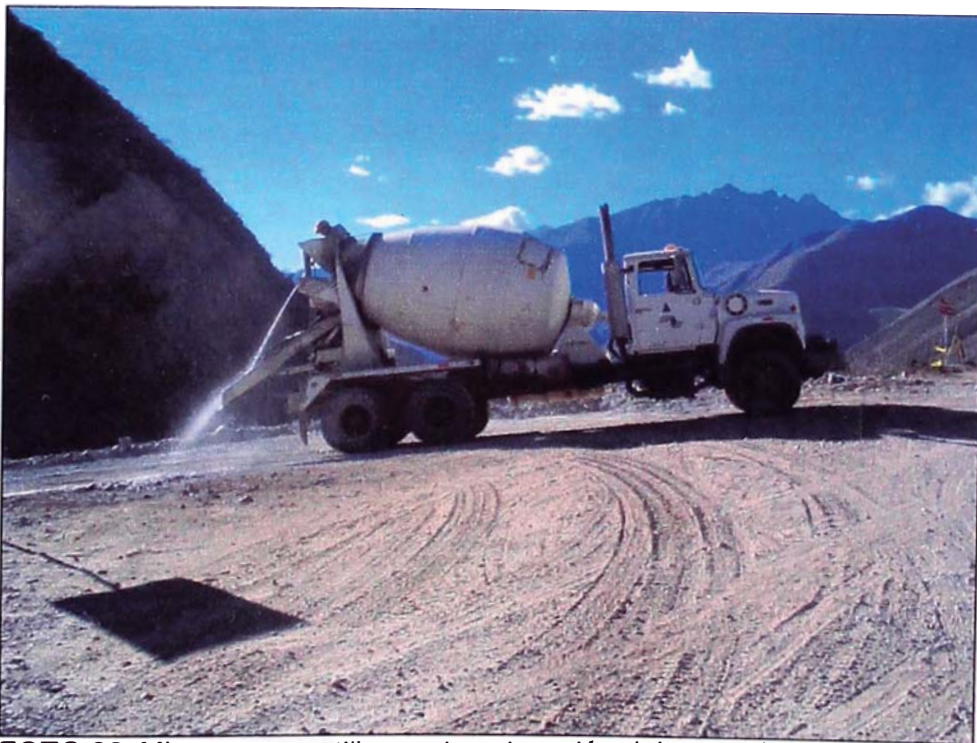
Mixer que se utilizo en la colocación del concreto.
